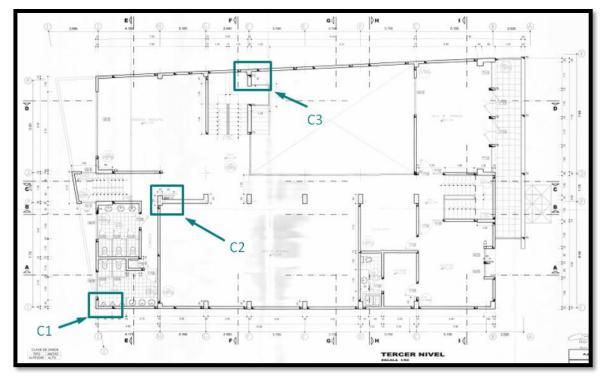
Columnas seleccionadas del 3° nivel. Fuente: Propia
